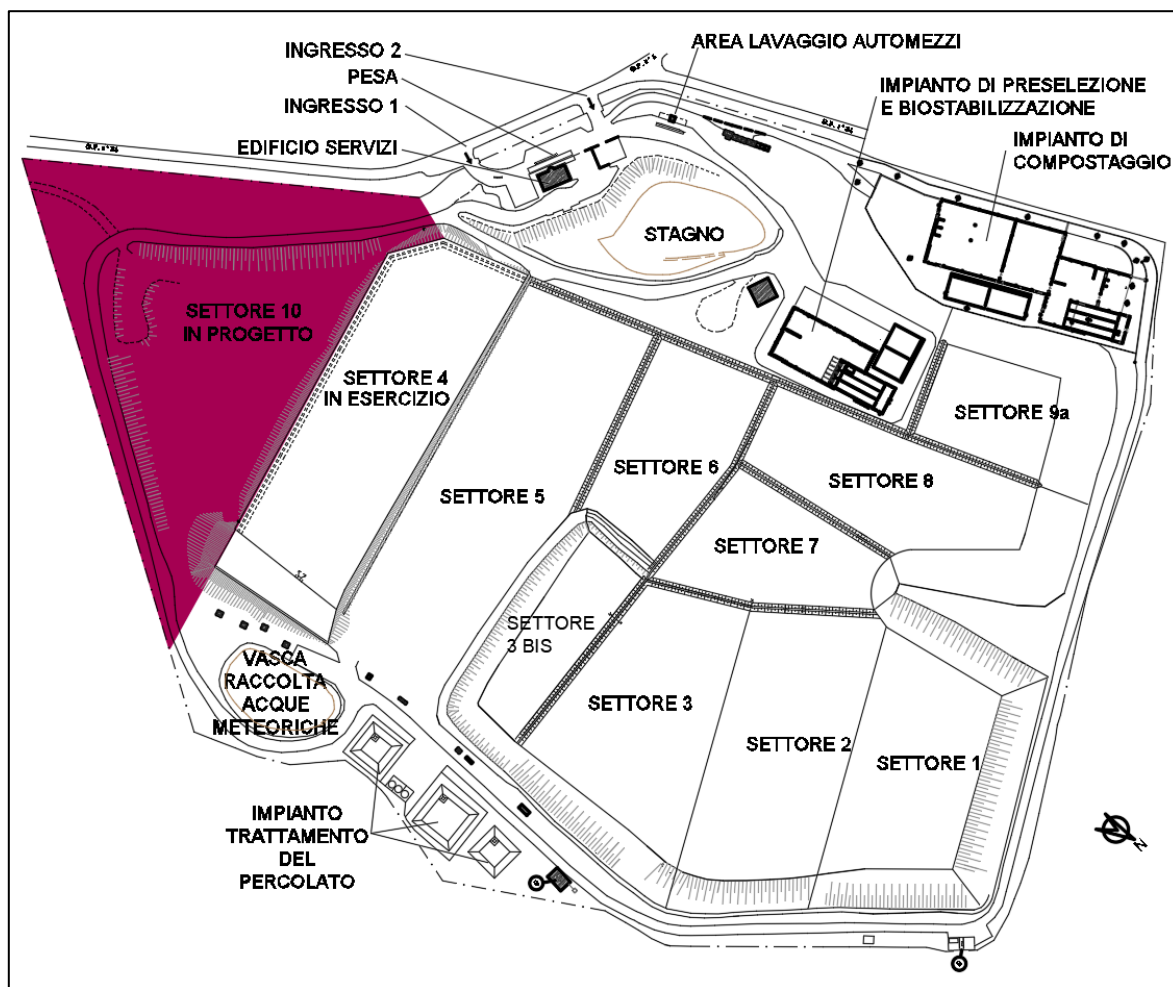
/A: Planimetria generale impianto - Stralcio della planimetria di progetto
